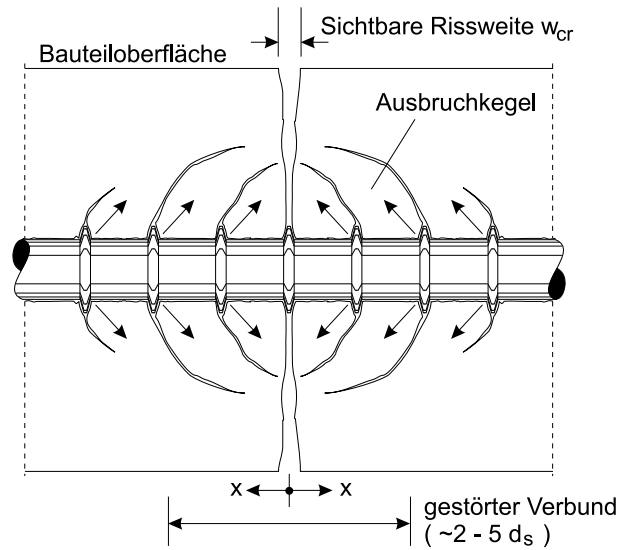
Detail eines Stahlbetonzugstabs, Ausbruchkegel des Betons infolge statischer Belastung nach [103]
